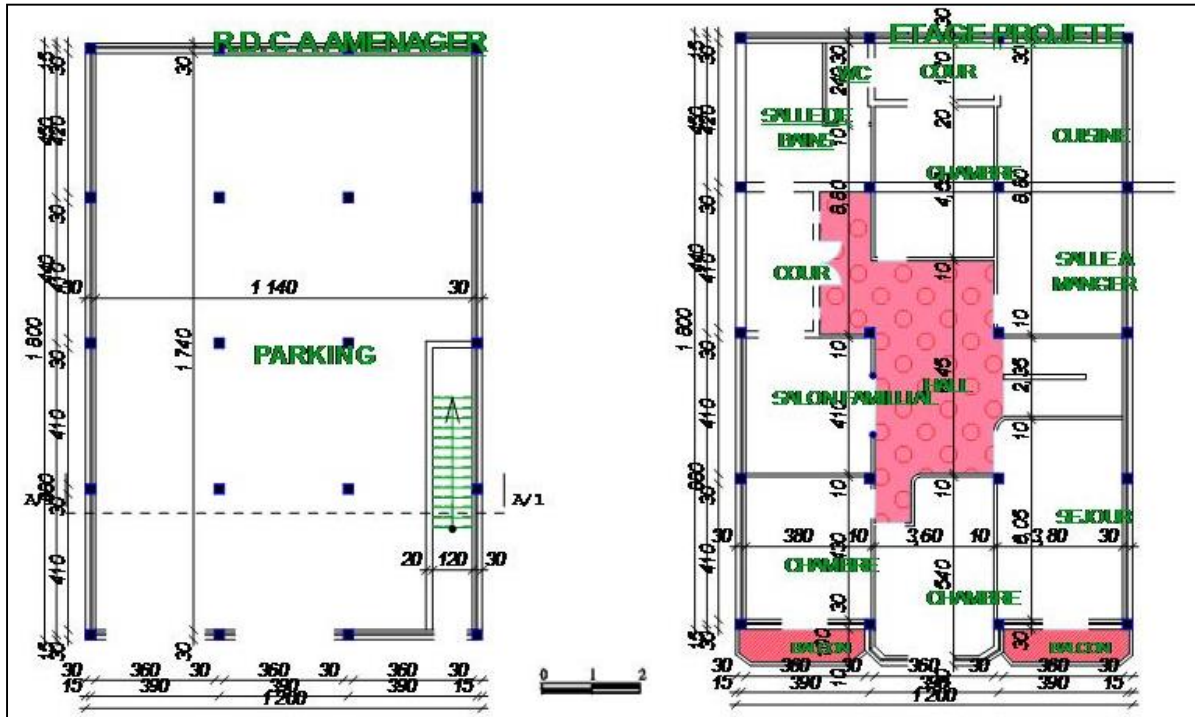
, échantillon 03, représentation graphique d'un plan RDC réalisé et d'un ETAGE projeté, lotissement ENNAHDA
